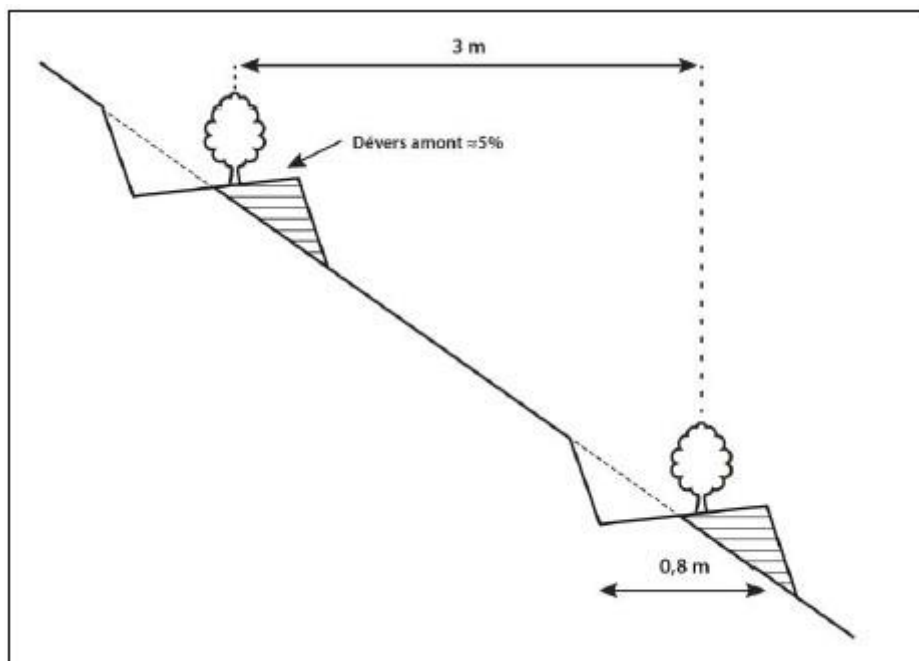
Schéma d'espacement des banquettes de plantation ; source : PRO – Accord Franco Andorran -boisements Pare-Congères -2024
